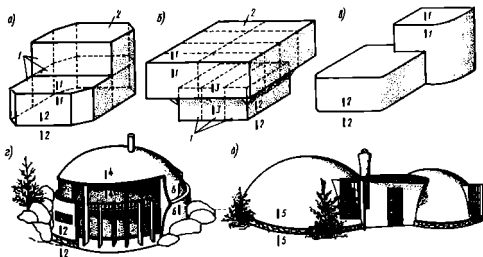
Примерные схемы нестандартных решений малоэтажных жилых домов из монолитного бетона:
